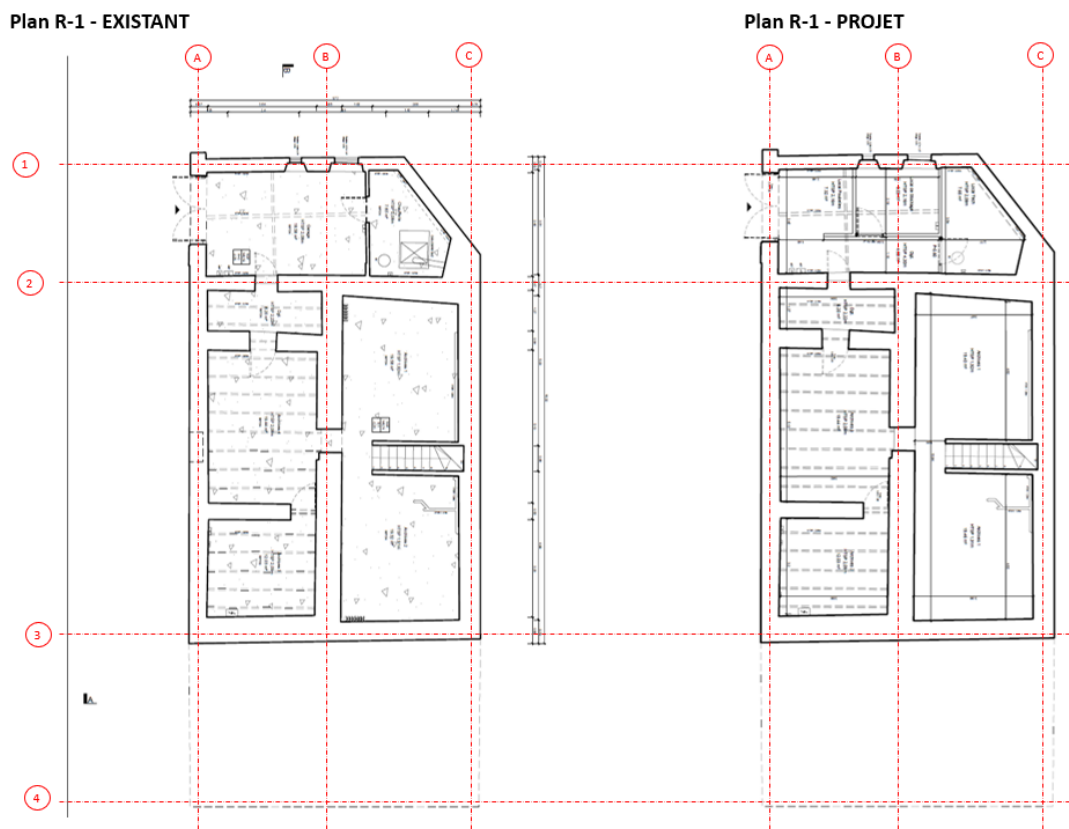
Plan architecte R-1, états existants & projeté, juin 2022
